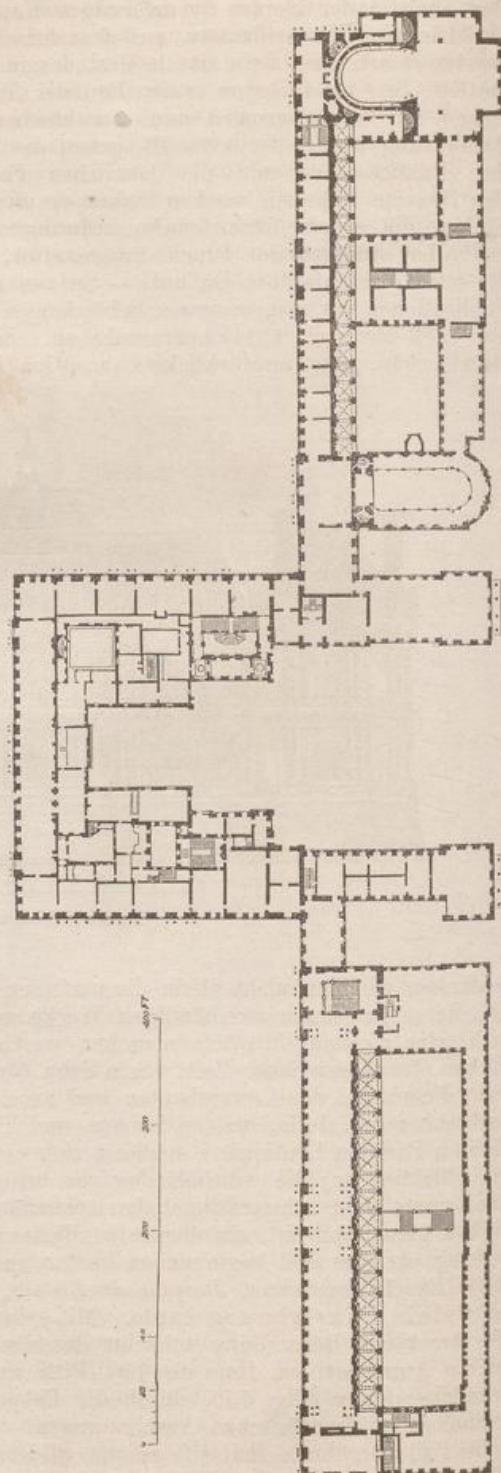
Grundriss des Schlosses von Versailles.
